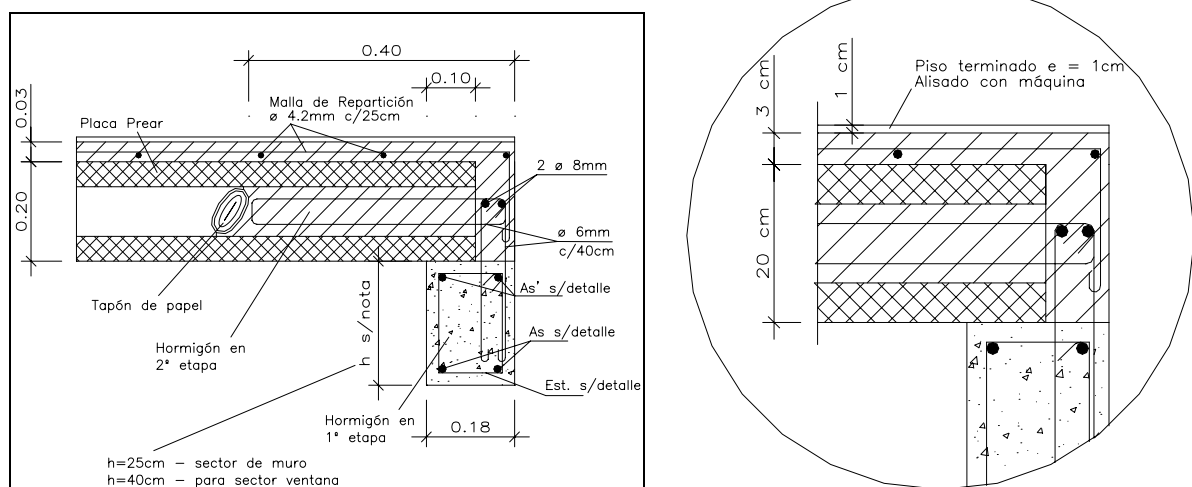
Detalles generales de las placas prefabricadas utilizadas como losas de entrepisos y cubierta de techo.
